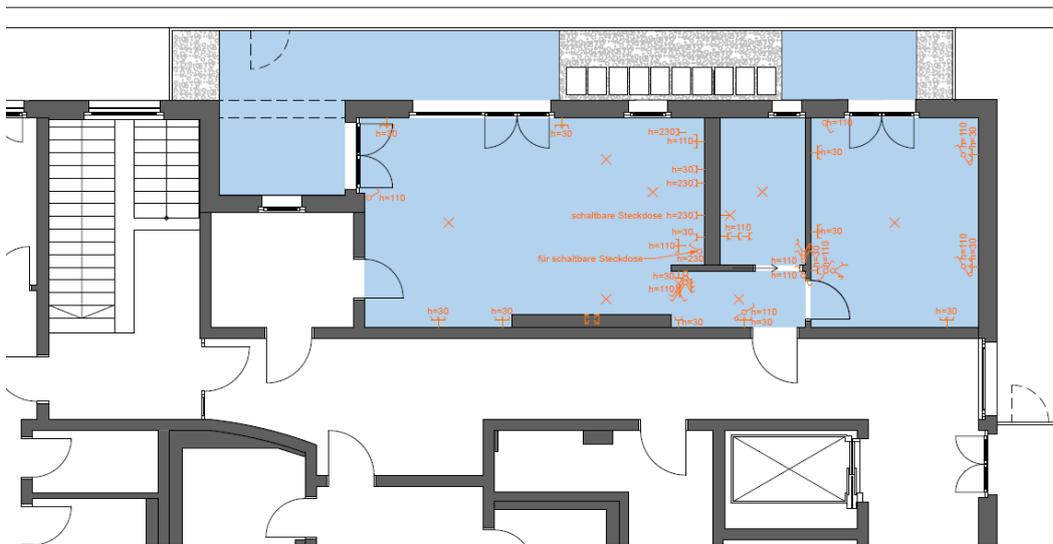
Grundrissplan möbliert mit Erstausrüstung
